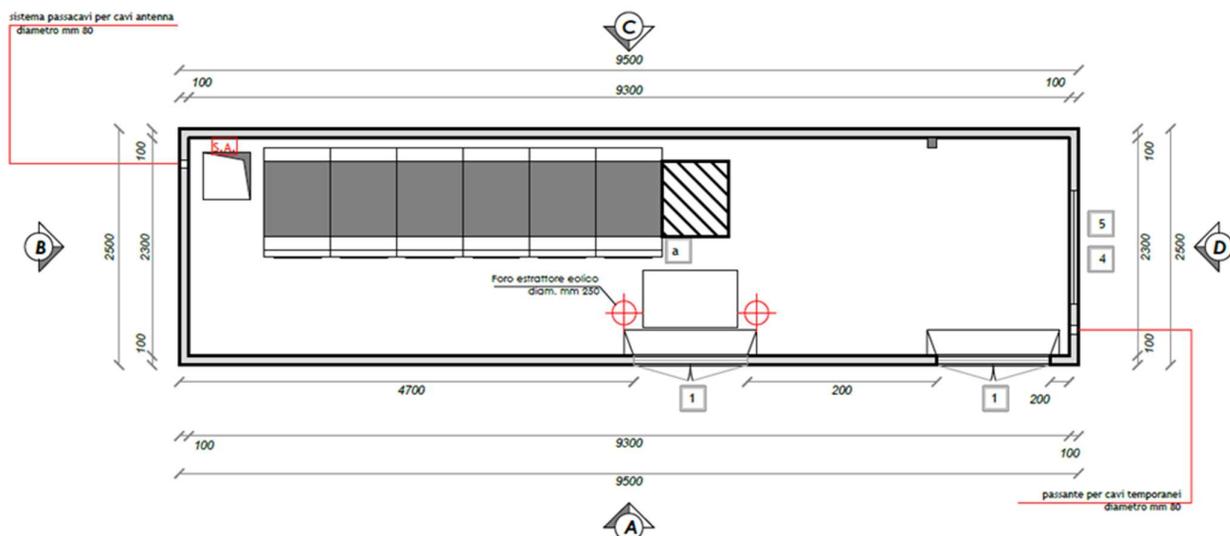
Planimetria cabina di raccolta – vista dall'alto
